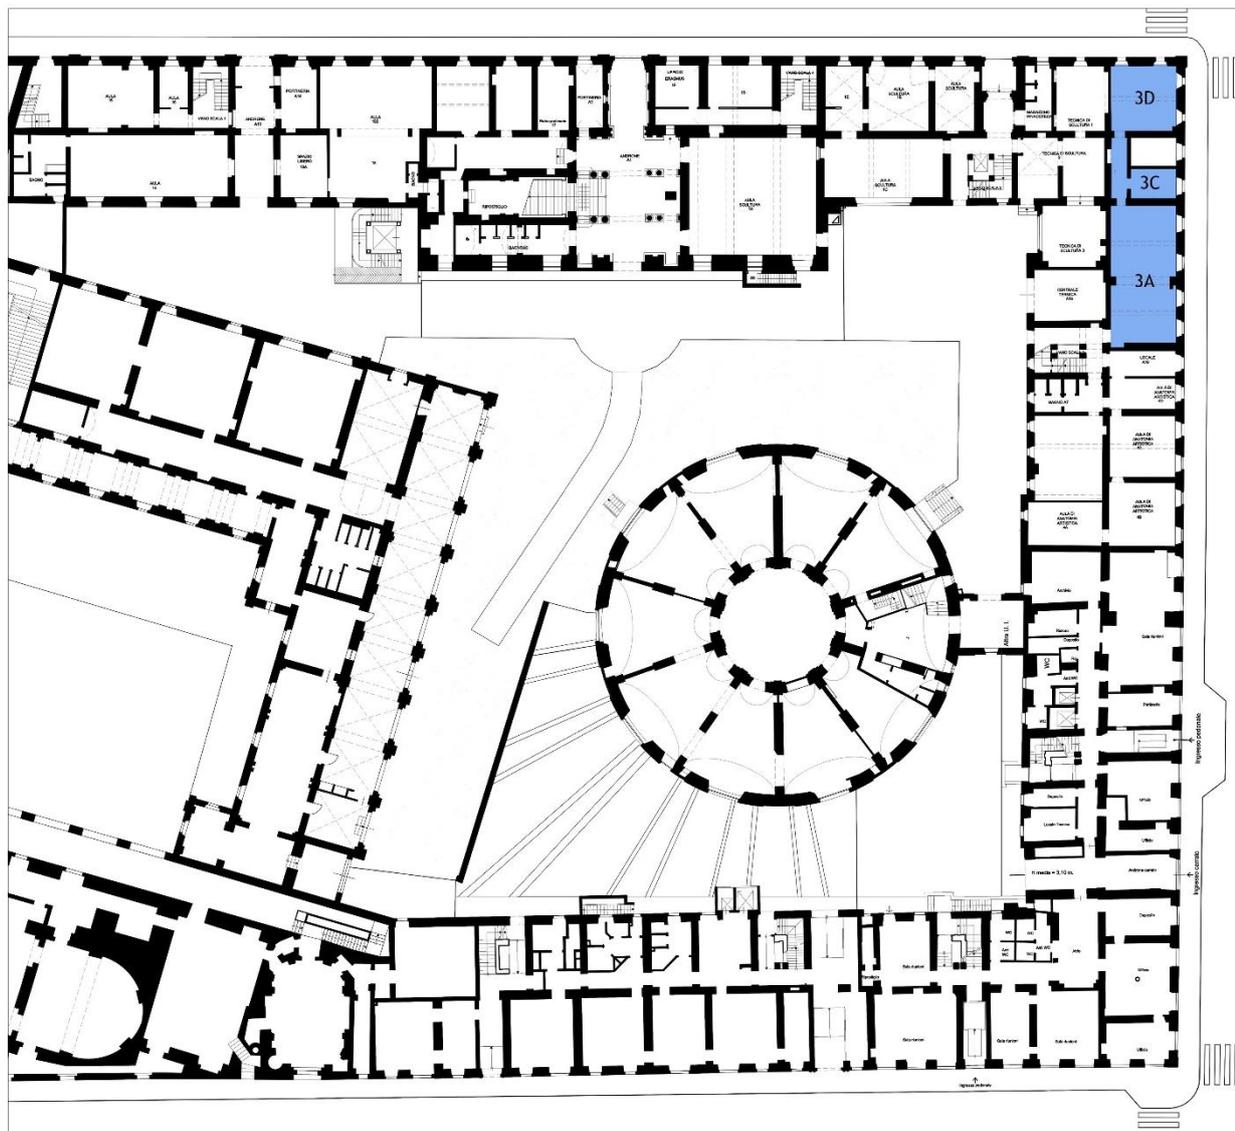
Pianta dello stato di fatto che evidenzia il laboratorio di modellistica, piano terra.
